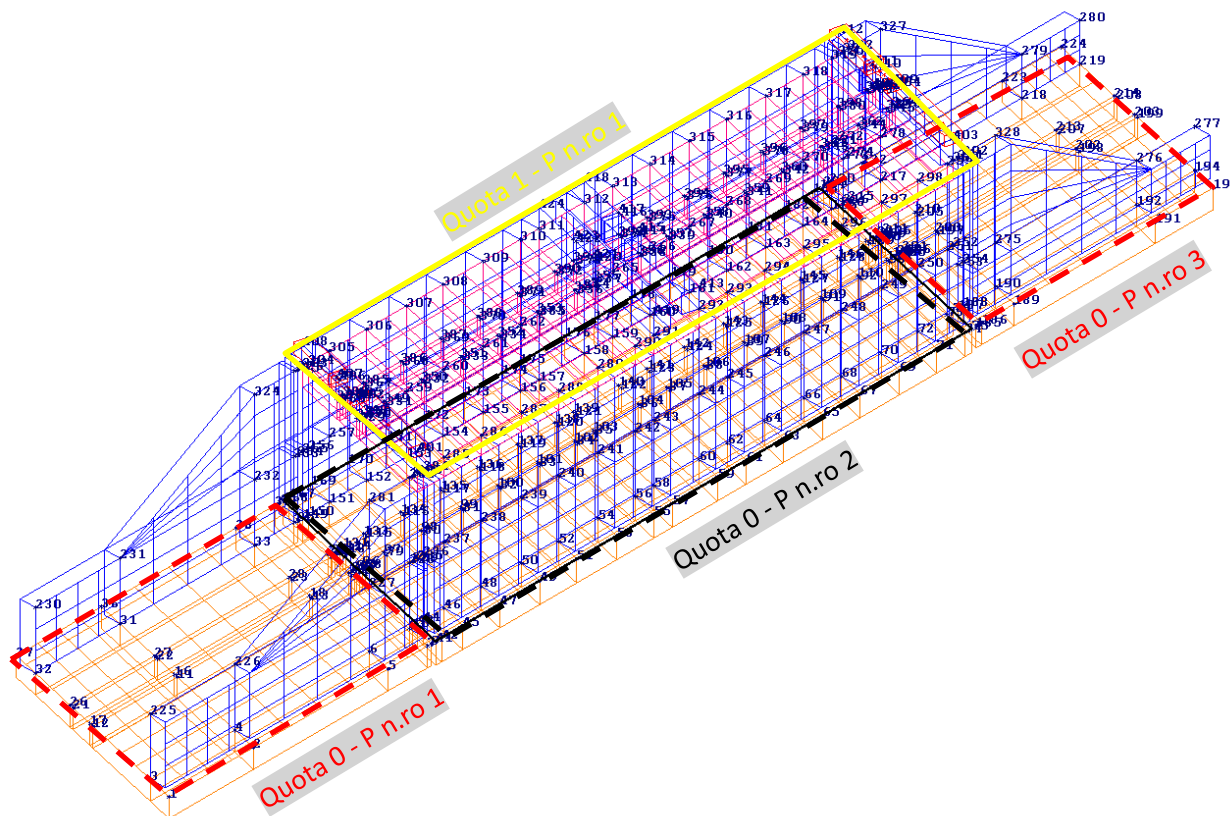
"Definizione dei perimetri delle piastre (di fondazione e di copertura)"
